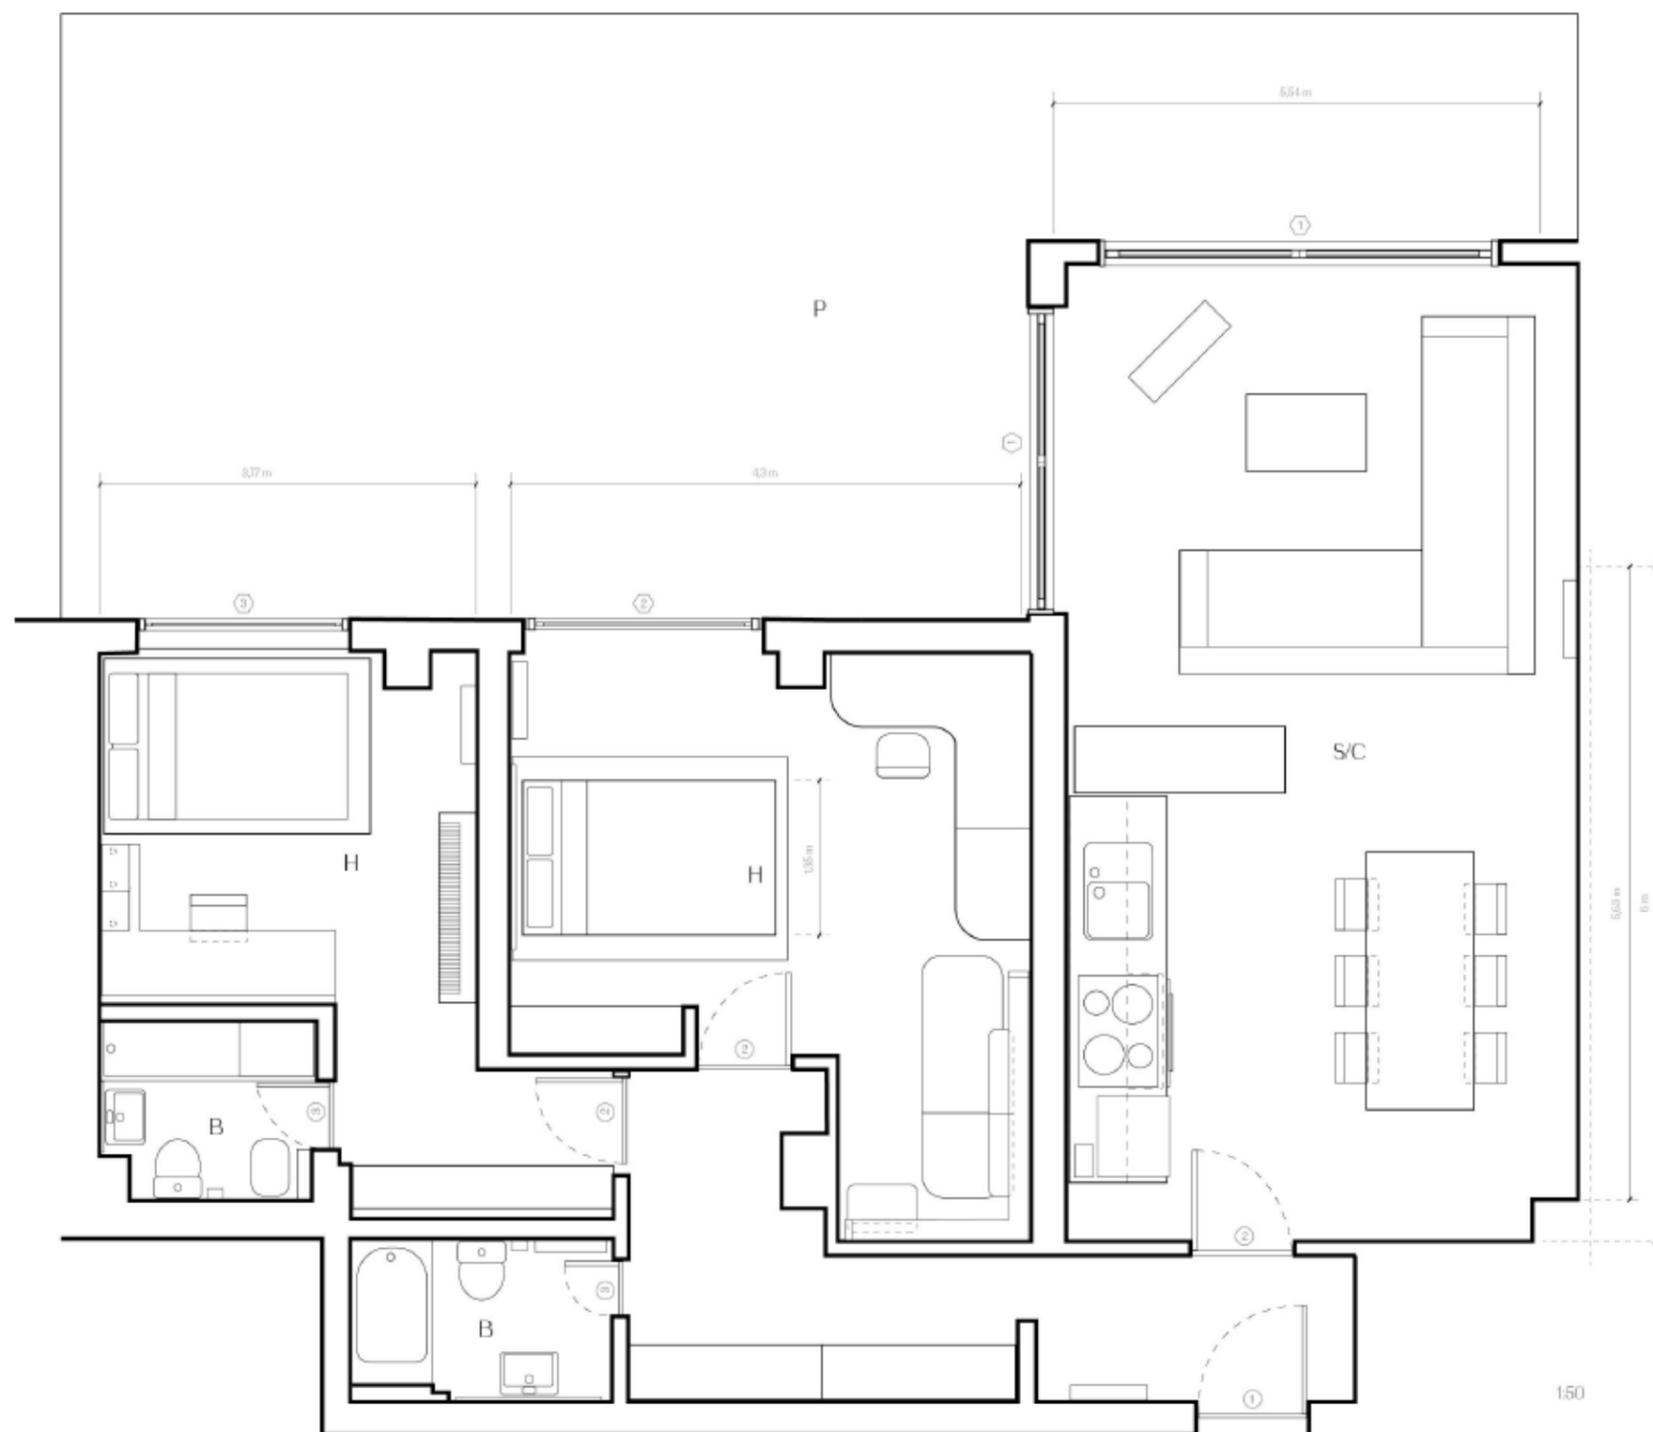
(Elaboración propia) Planta del emplazamiento reformado
